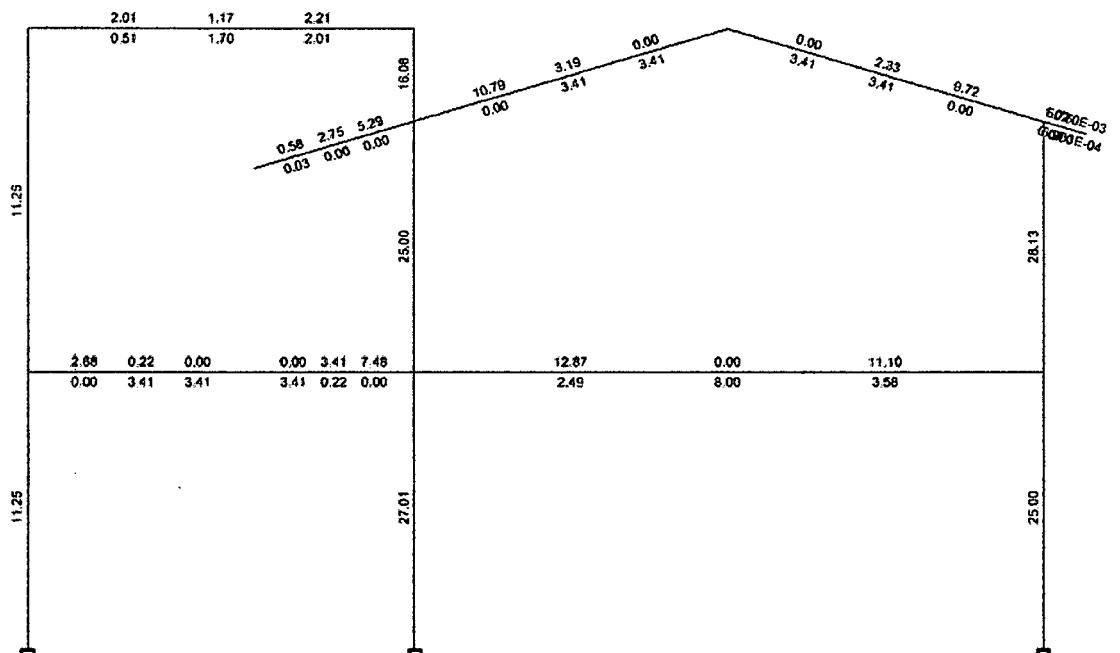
Áreas del acero de refuerzo en vigas y columnas calculado por el programa ETABS.
